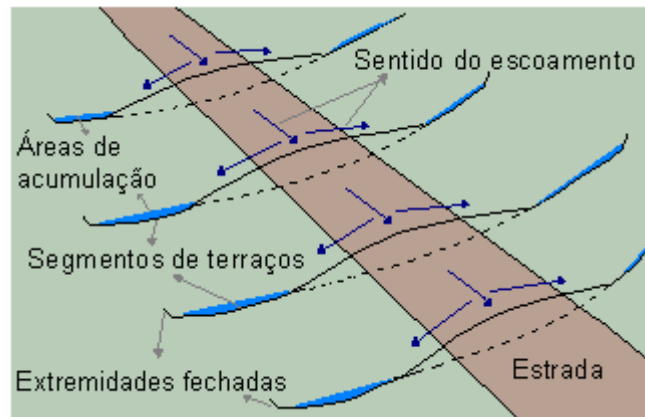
Esquema indicando a existência de estruturas para destinação e armazenamento de águas coletadas em estradas para serem infiltradas em áreas marginais.
